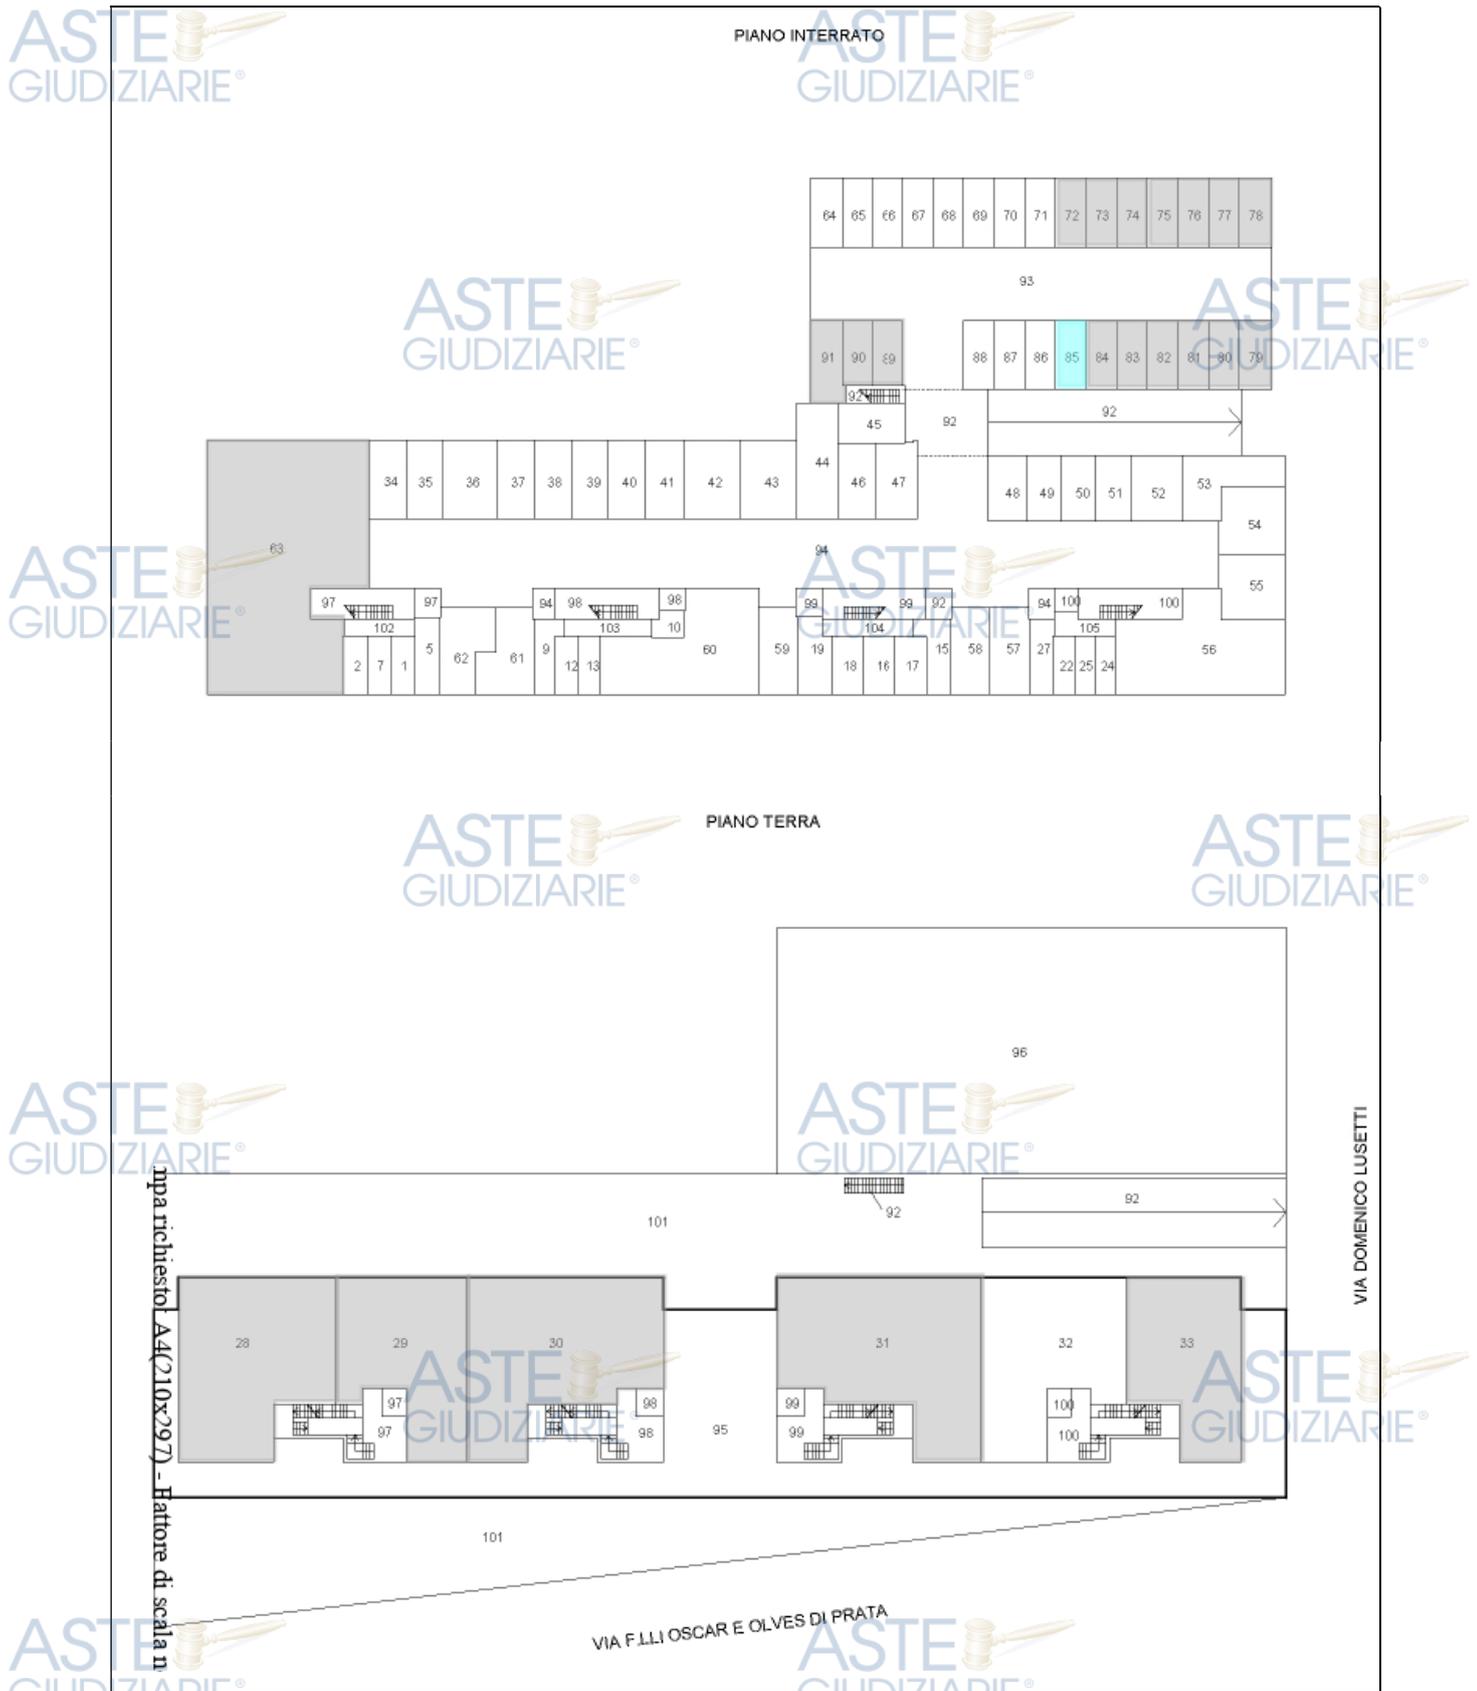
Individuazione immobili su elaborato planimetrico catastale
